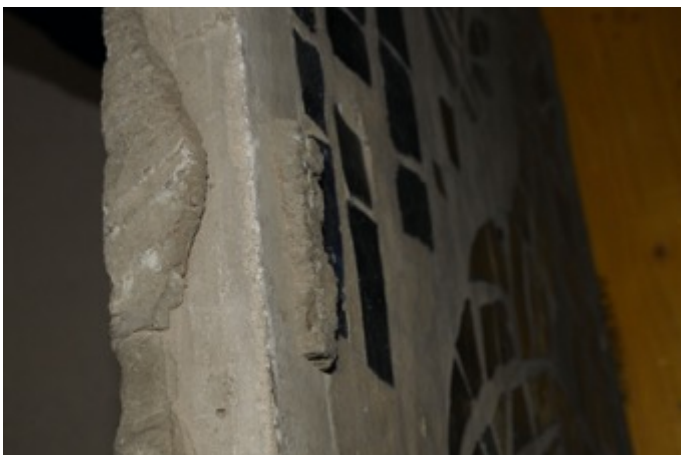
Traces du scellement latéral des panneaux avec ciment rapide. Restes de ciment sur les bords d'un panneau (face externe et face supérieure).
